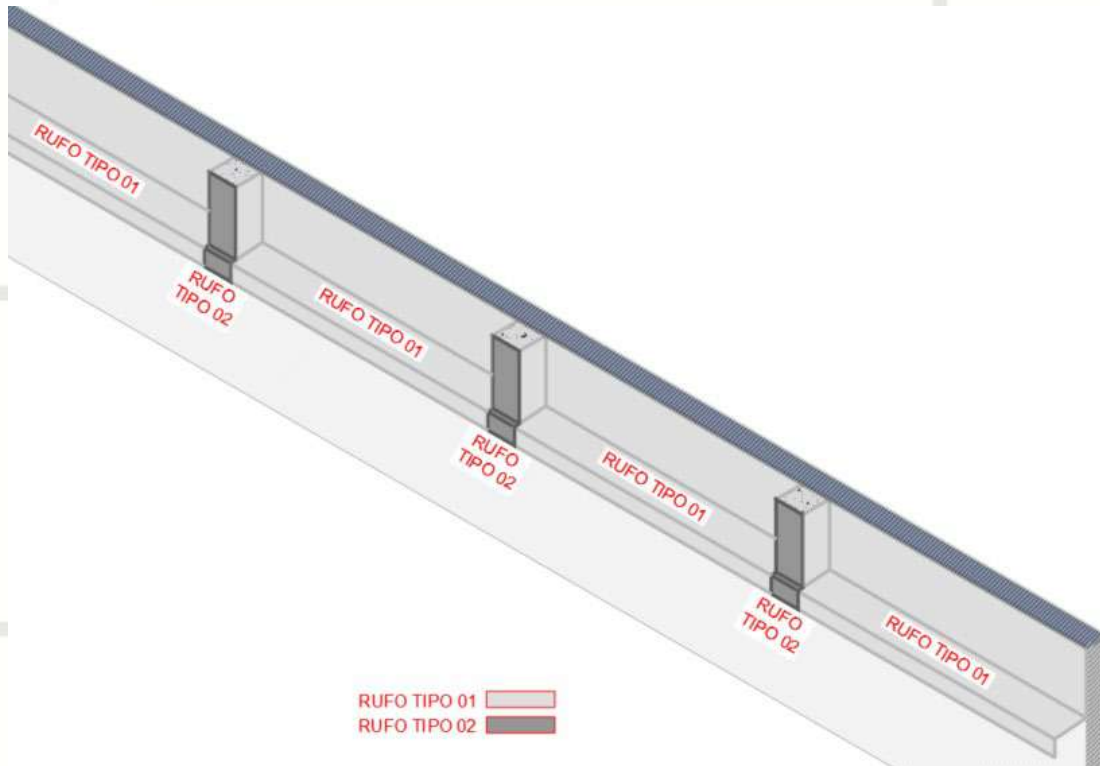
Exemplo de aplicação dos rufos metálicos no contorno dos pilares
